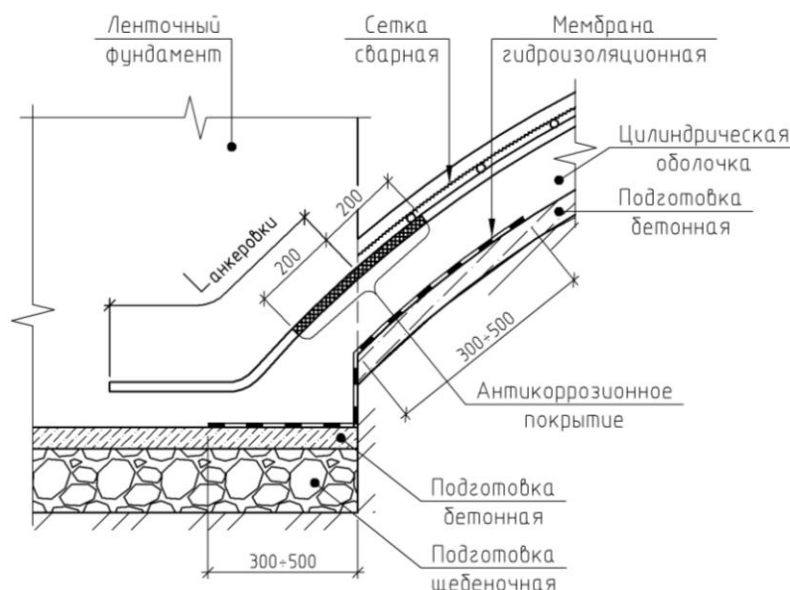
Конструкция узла сопряжения оболочки с ленточным фундаментом ЛОФ
